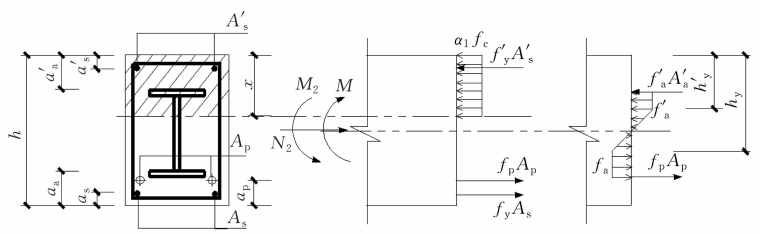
预应力型钢混凝土构件正截面受弯承载力计算
